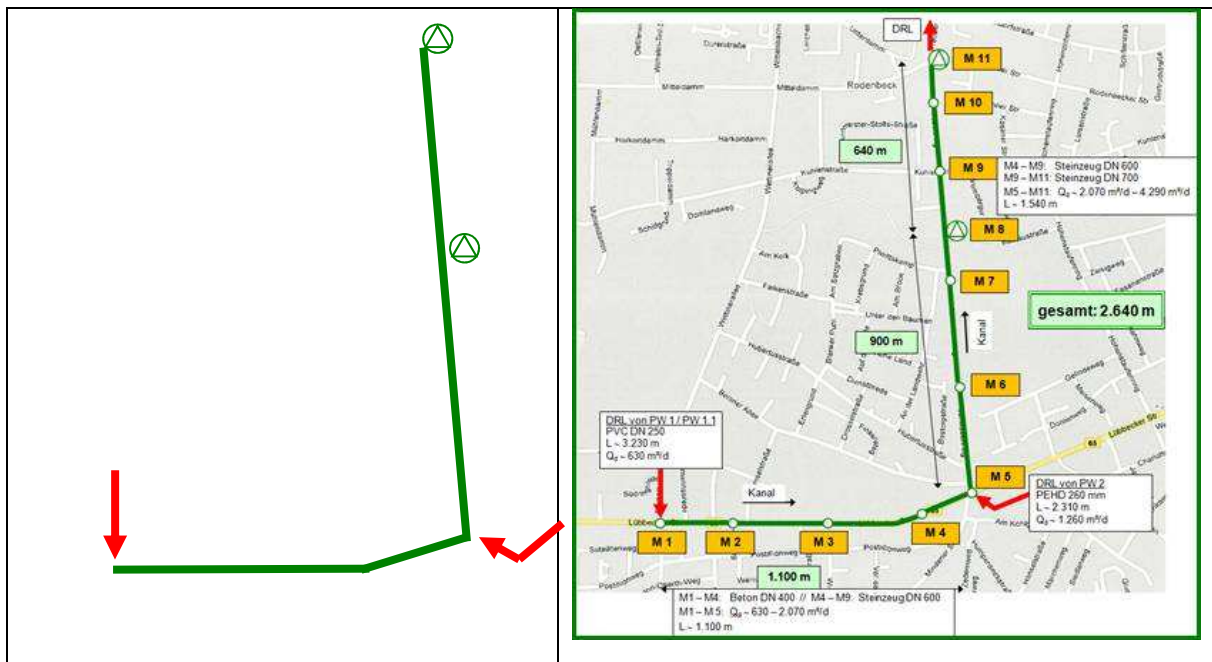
Lageplan Messstrecke (links) und Messstellenplan (rechts)
